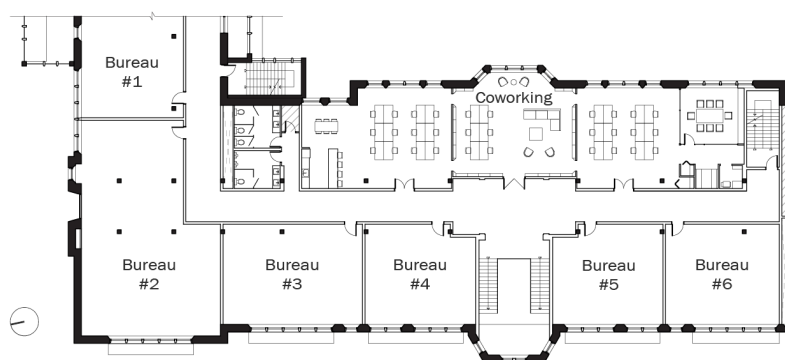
Plan du secteur des bureaux et du coworking à l'étage (voir Annexe II : niveau 1 pour plan complet) (par l'auteure)
